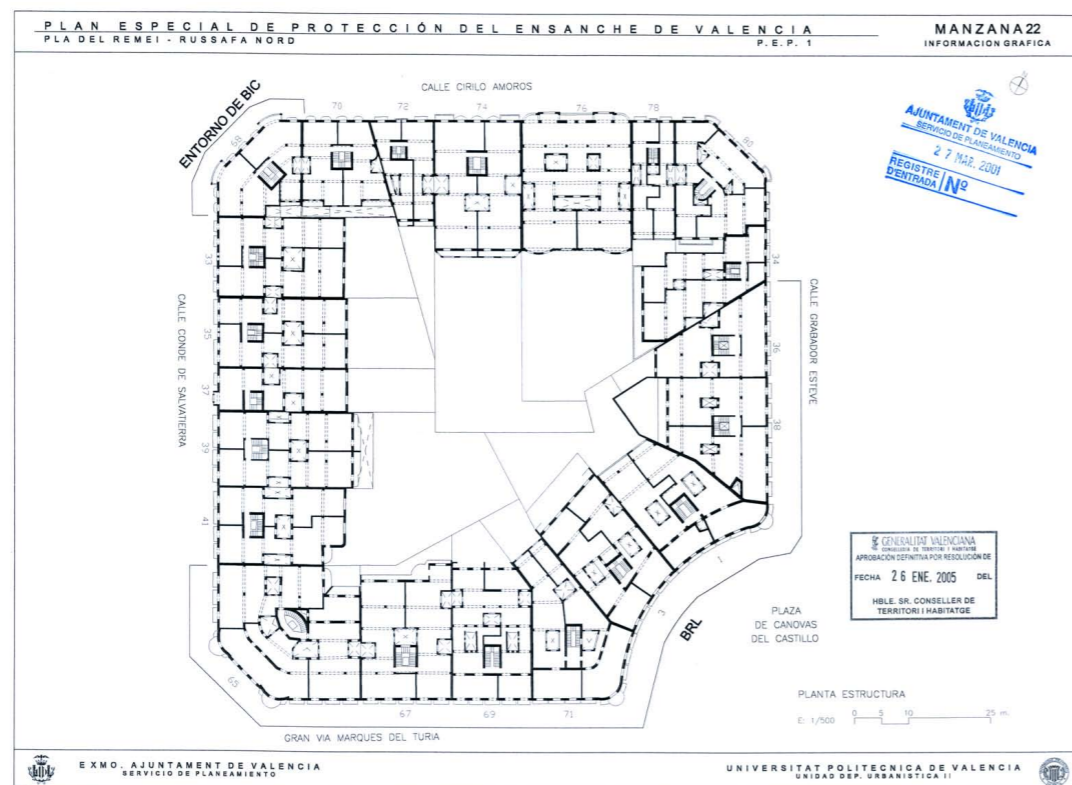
Plan de protección especial del ensanche de Valencia. Ficha del manzana. Planta estructura
